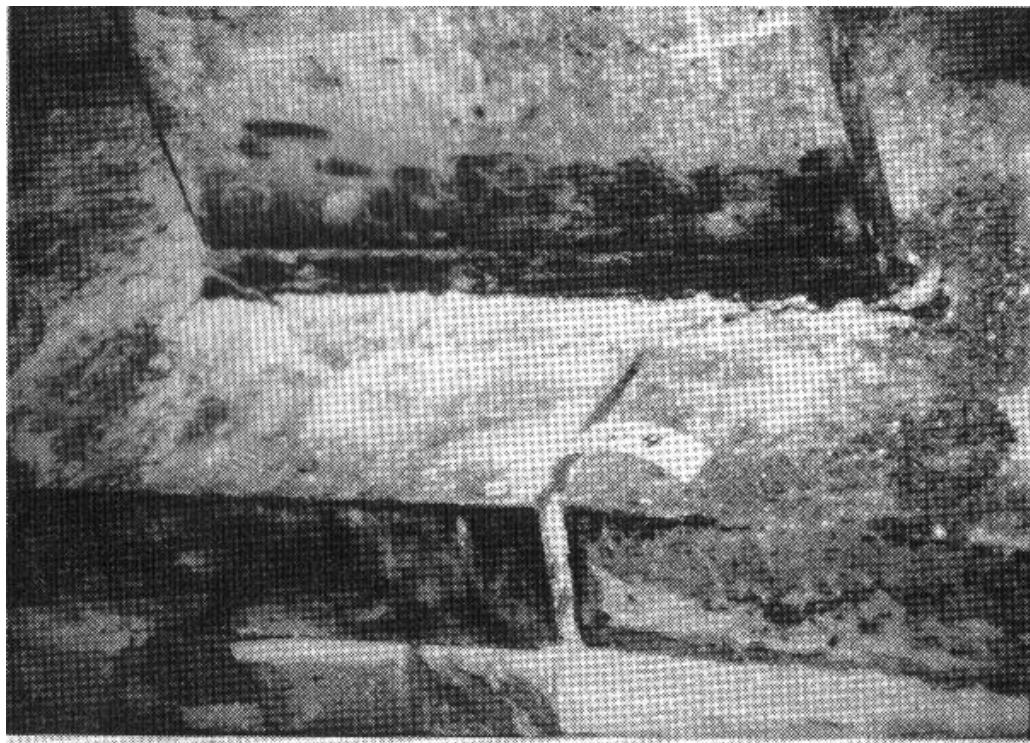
9.5.1.5 Se observa como la fisura se inicia en la conexión soldada, para luego extenderse y finalmente atravesar todo el espesor de la plancha. Ref. 5
